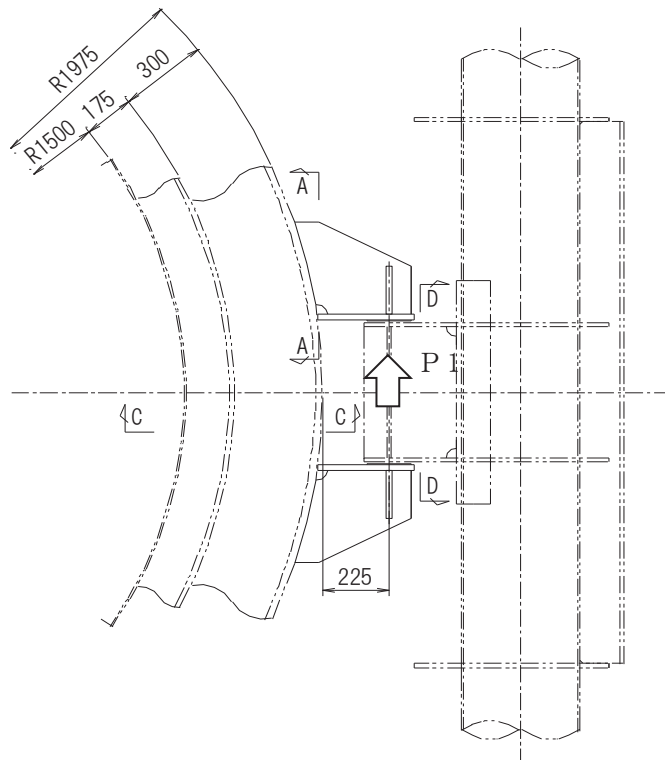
(2) 第 2 支持点部の支持金物の平面図及び支持点荷重 (単位 : mm)
